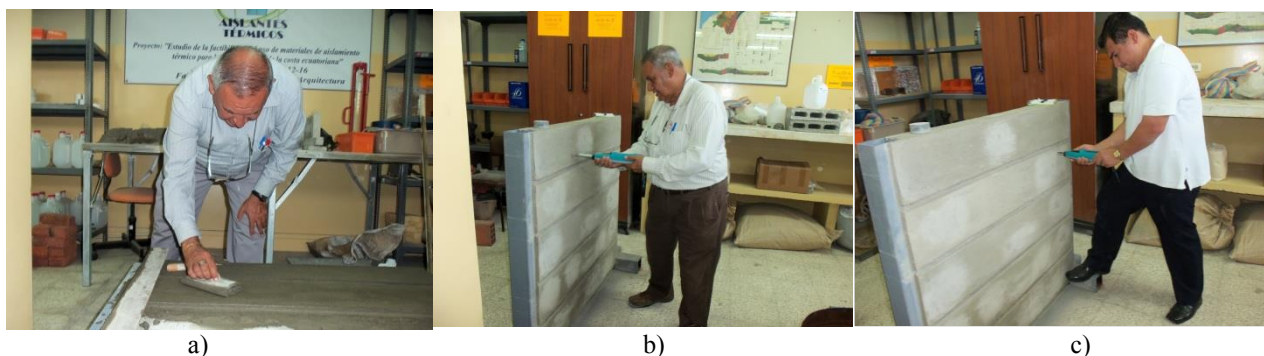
a) Aplicación del mortero en mampostería de prueba en laboratorio. En b) y c) Toma de resistencia del mortero con el esclerómetro.
